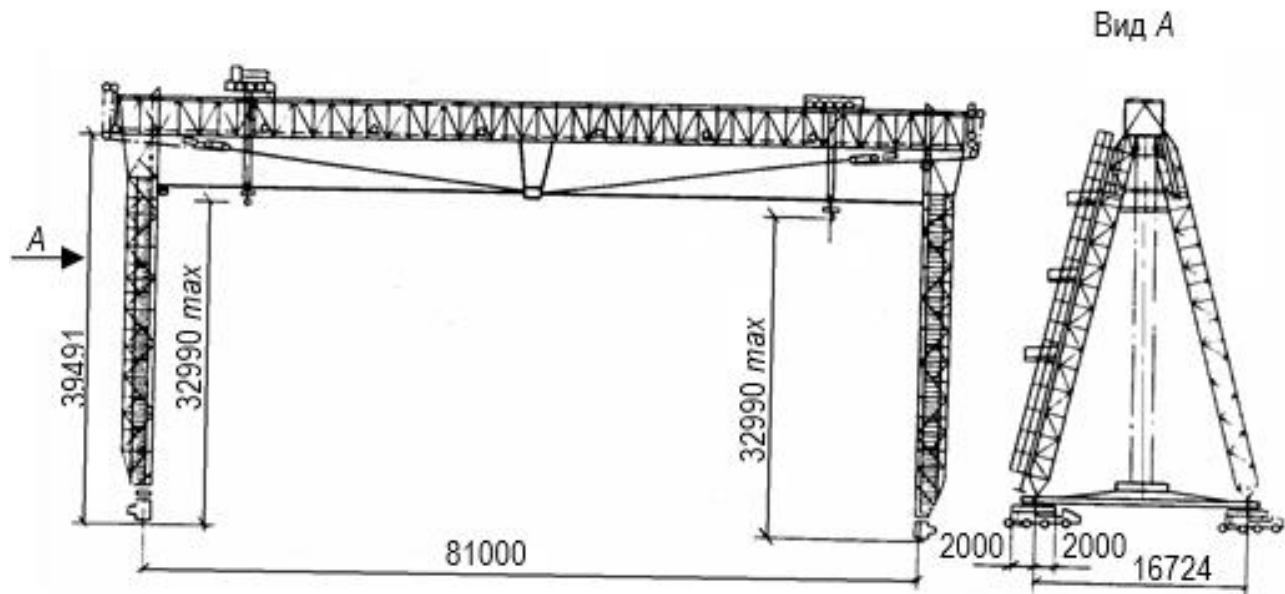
Уникальный козловой кран УКП-100-81, применявшийся при монтаже большепролетных конструкций покрытия Театра оперы и балета в Харькове
